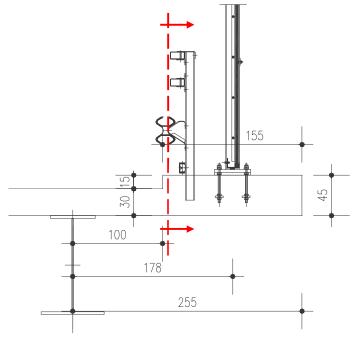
Geometria dello sbalzo e individuazione sezione di verifica
